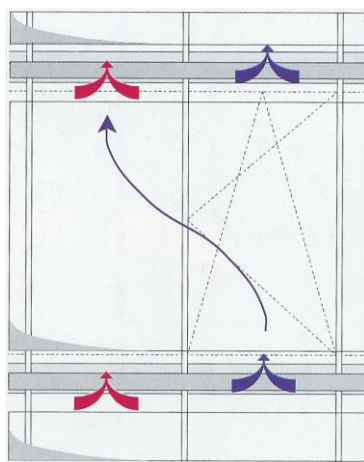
Cross ventilation negli elementi prefabbricati [2]
